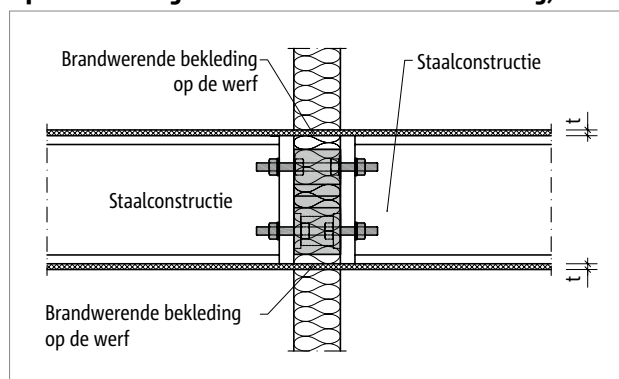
Schöck Isokorb® type SQ: op de werf aangebrachte brandwerende bekleding, type SQ en staalconstructie met brandwerende coating; doorsnede
